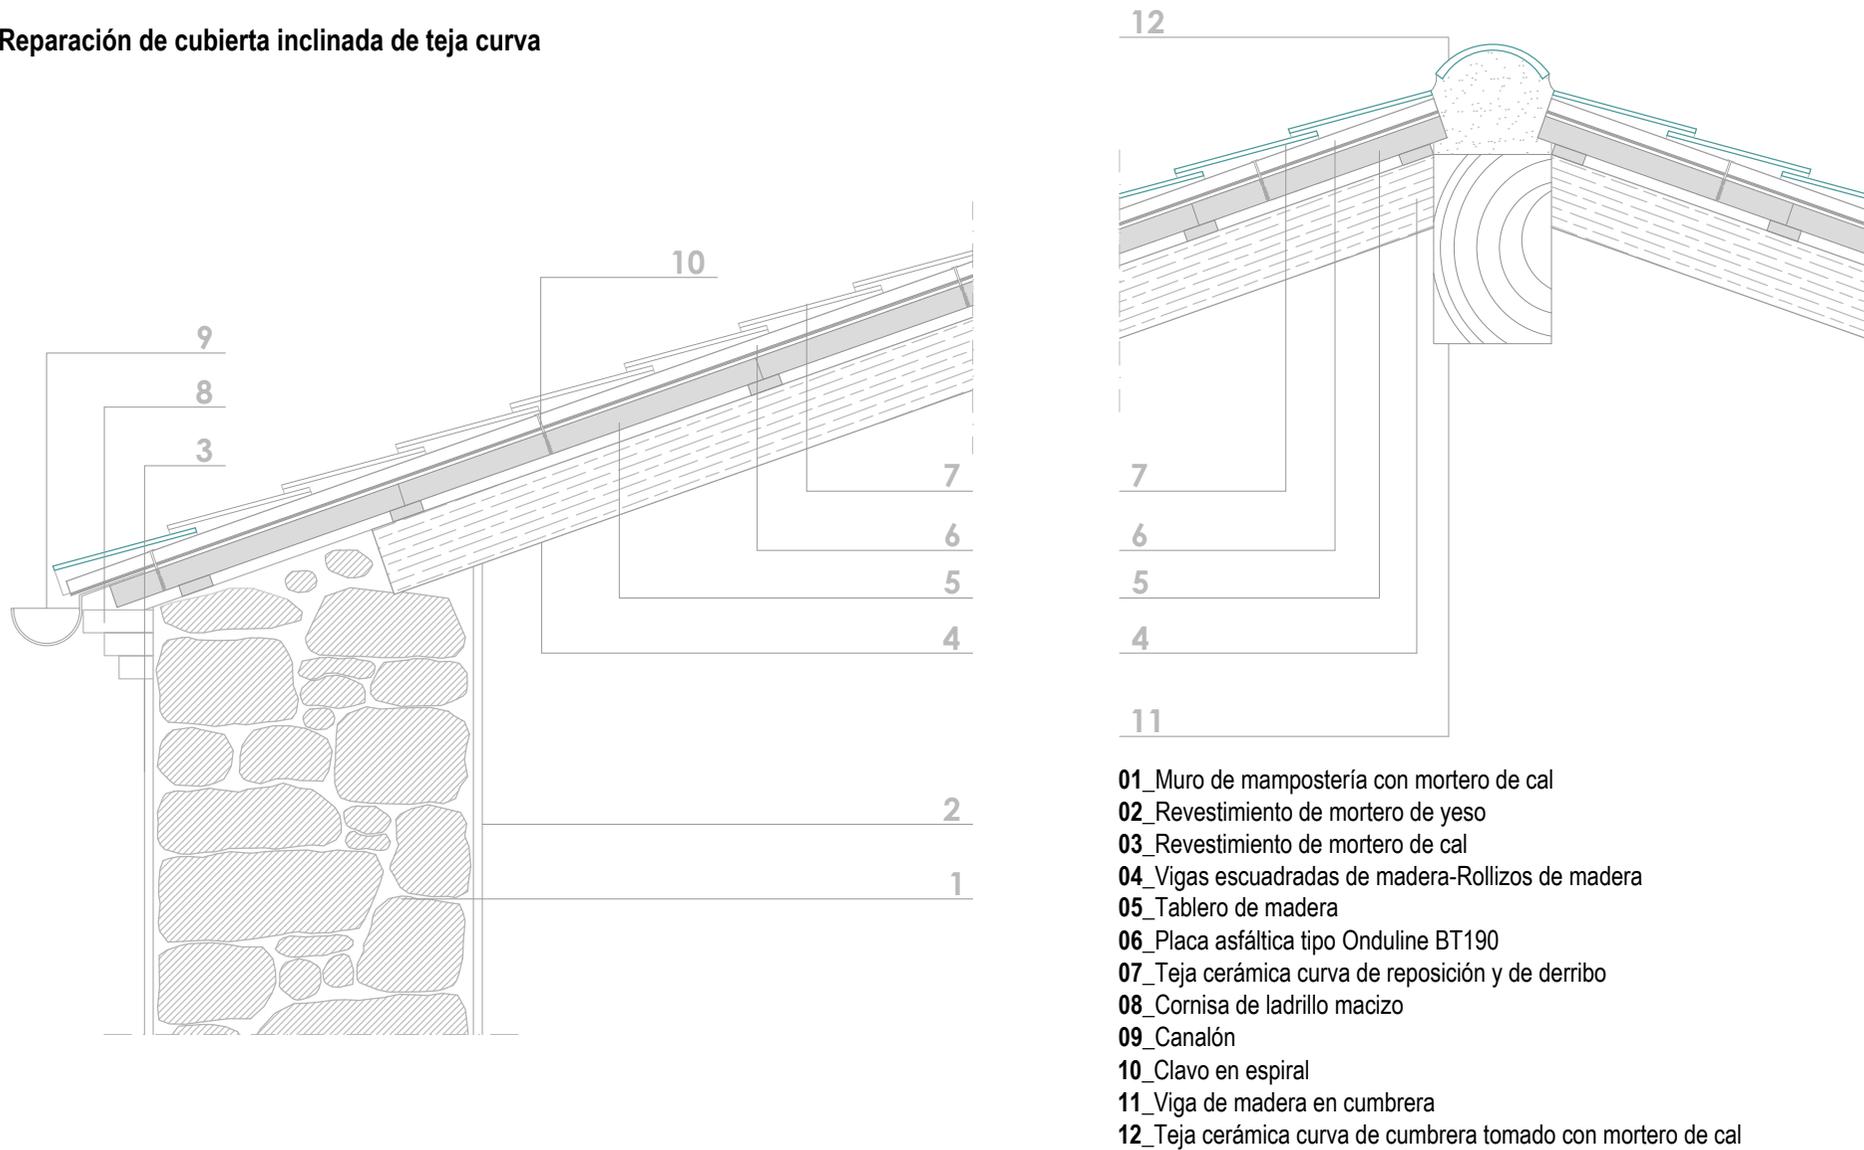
Reparación de cubierta inclinada de teja curva mediante colocación de tablero de madera y placa asfáltica
